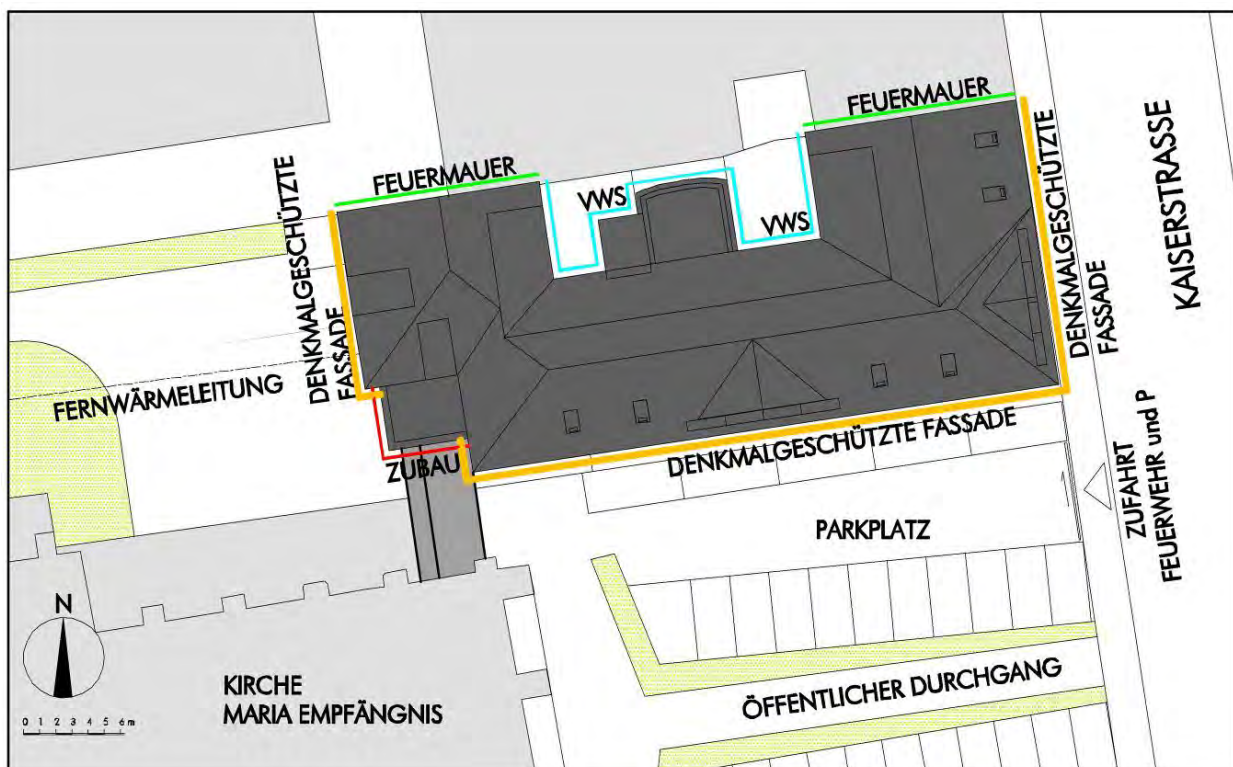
Lageplan Demonstrationsprojekt (Quelle: Architekten Kronreif_Trimmel&Partner)
